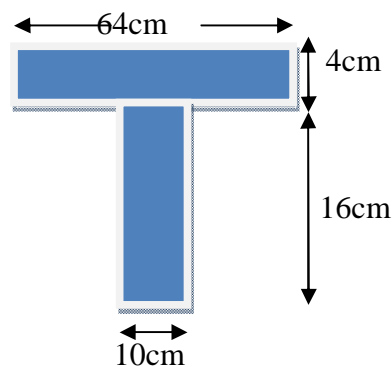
Schéma représentant la section transversale d'une poutrelle
